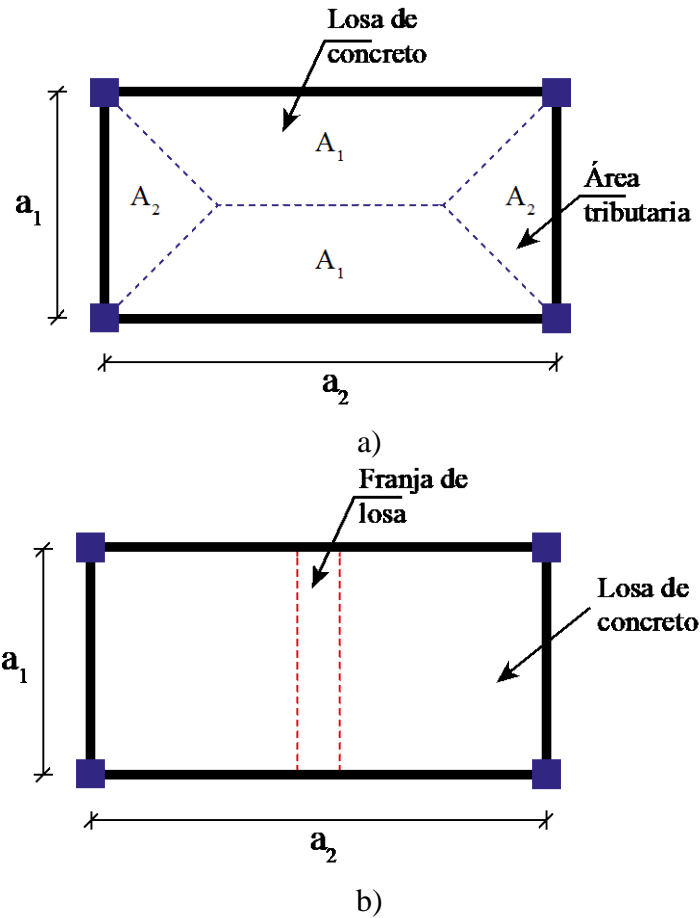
Distribución de cargas sobre: a) vigas y b) franja de losa
